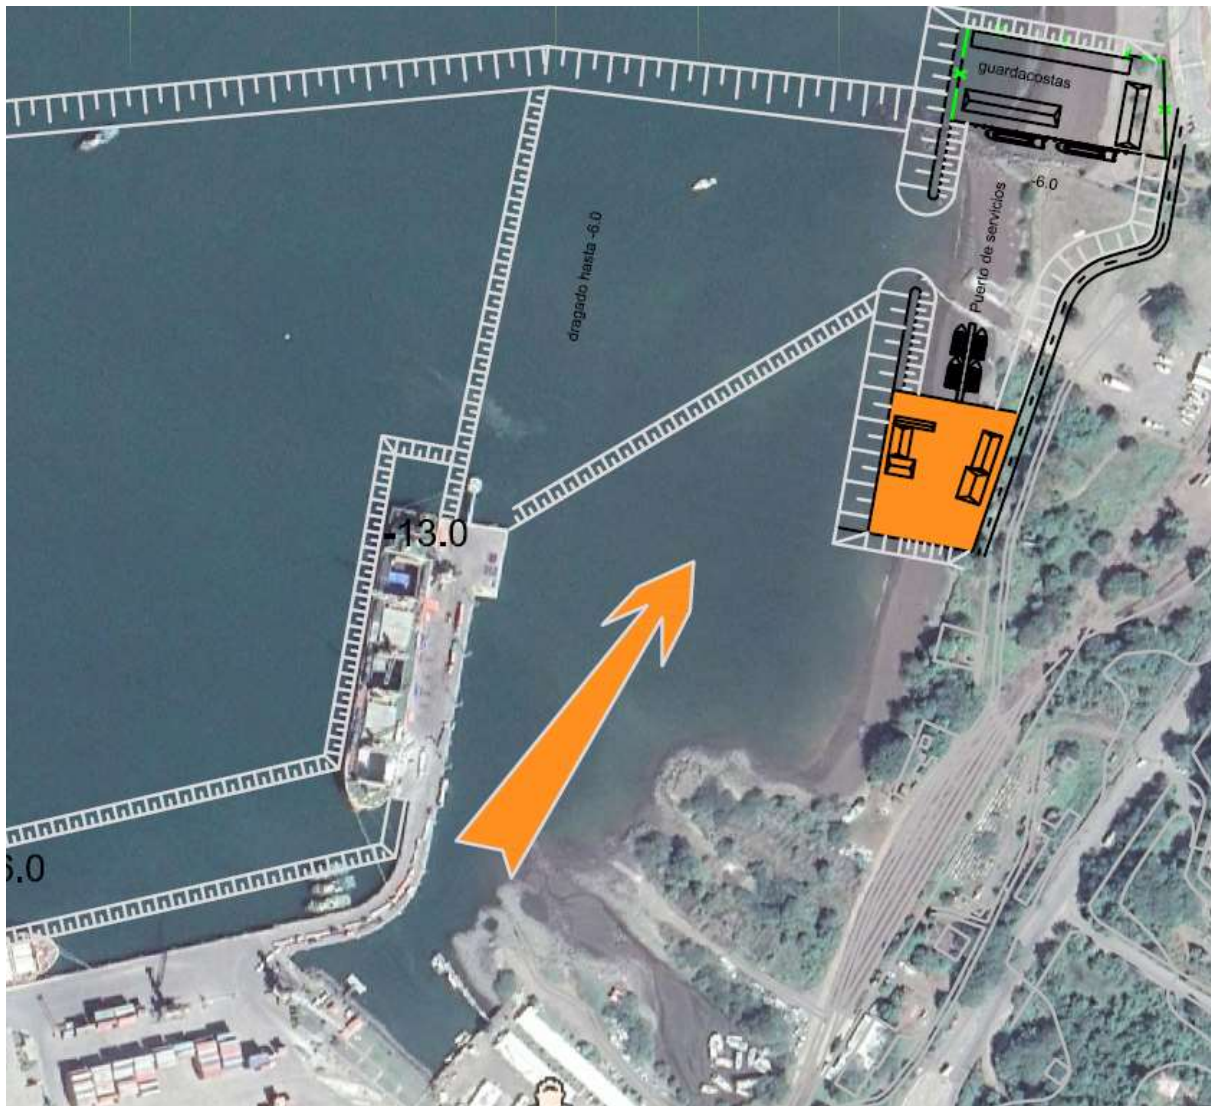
Fase A, Etapa 2 de construcción, reubicación del puerto de servicio
